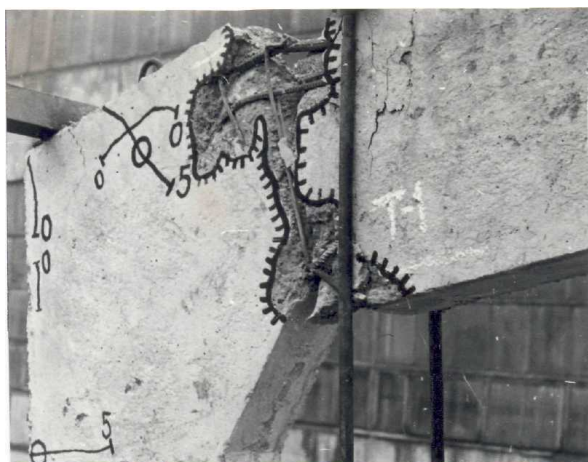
Узел сопряжения ригеля со стойкой сплошной полурамы после испытаний
